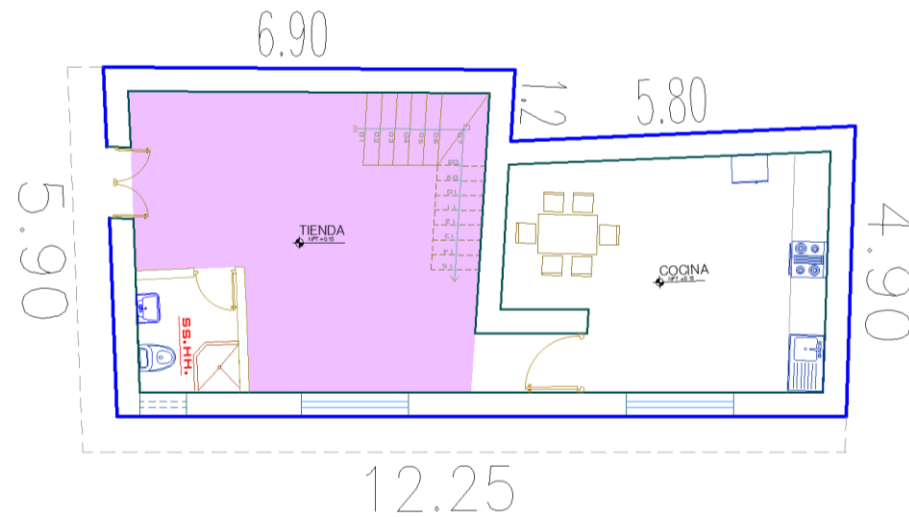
Plano de distribución de las viviendas donde se brinda la oferta de la palta.
